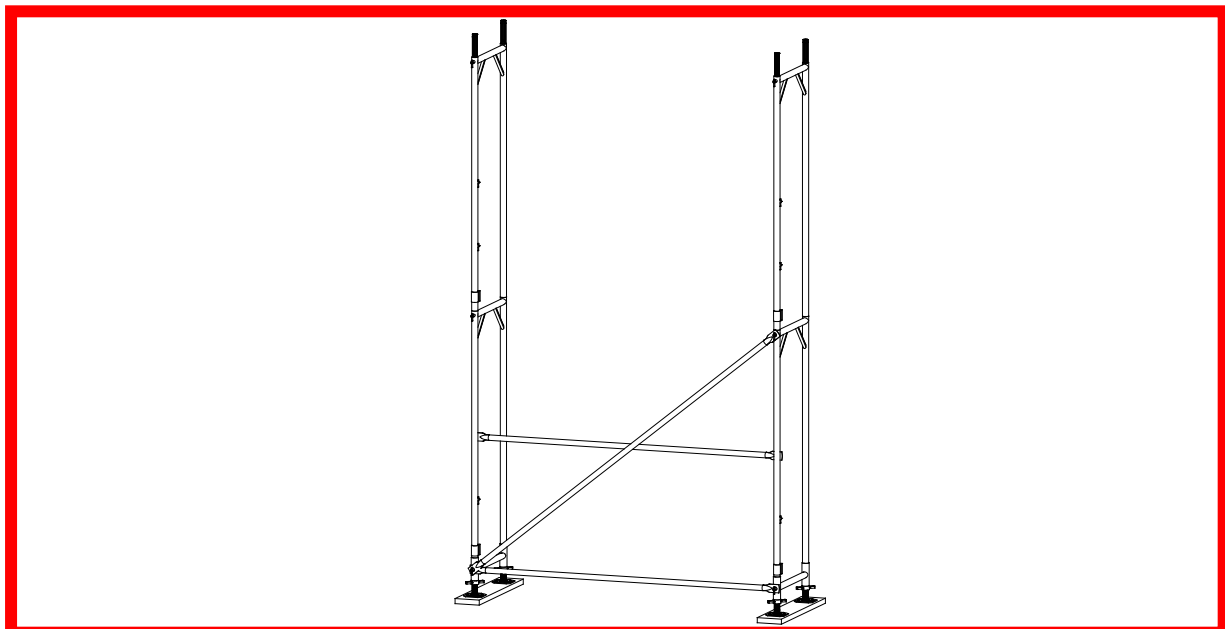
Aufbau des ersten Gerüstfeldes mit Vertikalrahmen 4,0m
